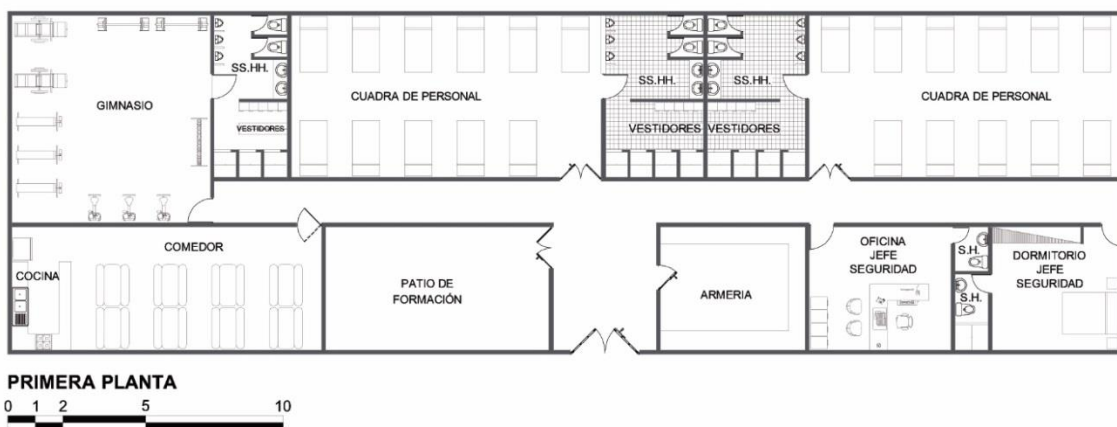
Primera planta de los servicios generales de la zona C
